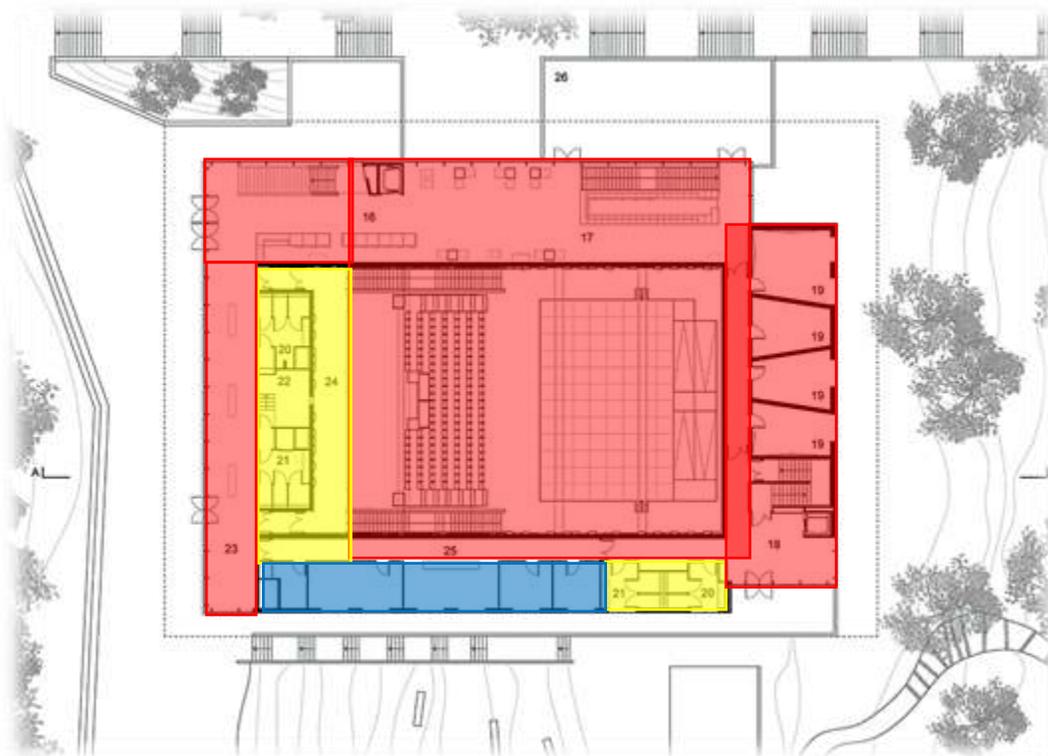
Planta Arquitectónica segundo nivel. Fuente: Hervé de Chastenot
